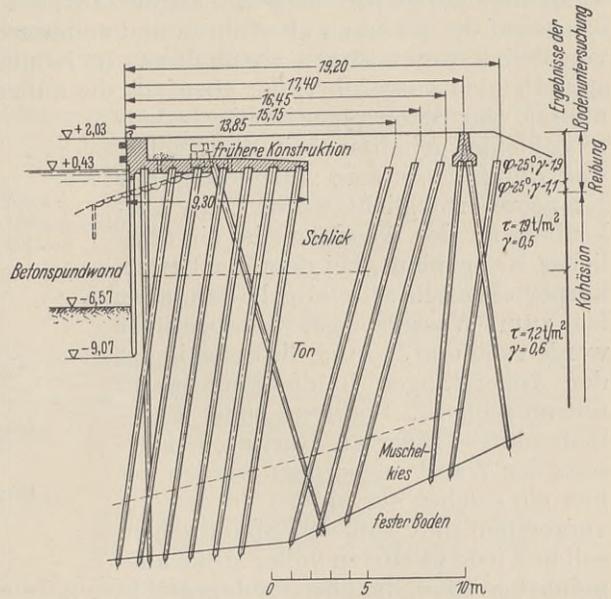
Betonkai auf Holzpfählen in Tonboden mit festem Untergrund, Uddevalla, 1935.
